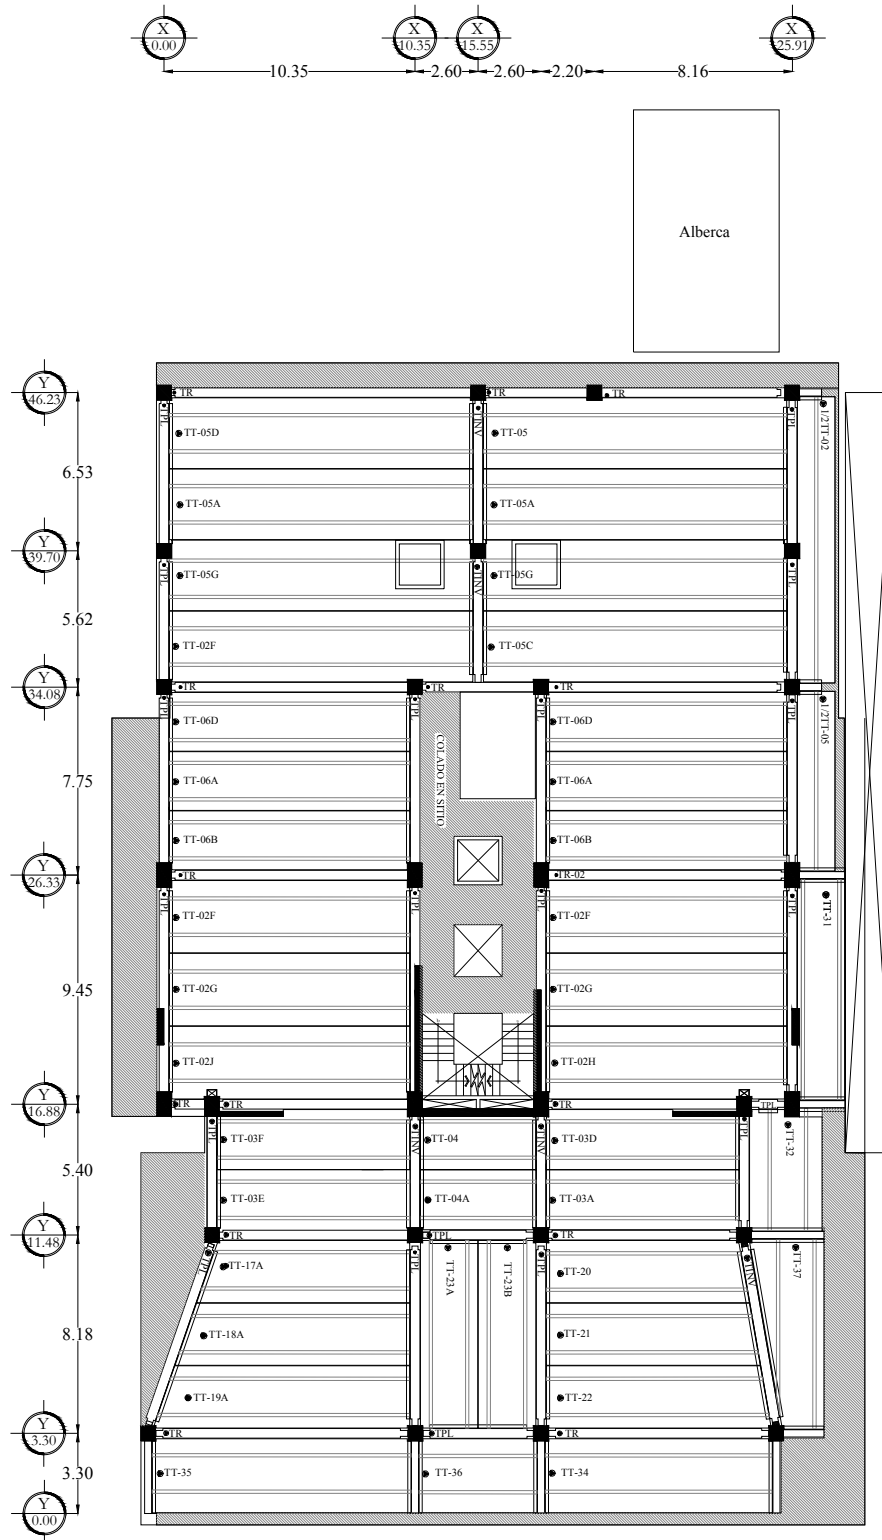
Planta estructural del segundo nivel, cotas en m.
